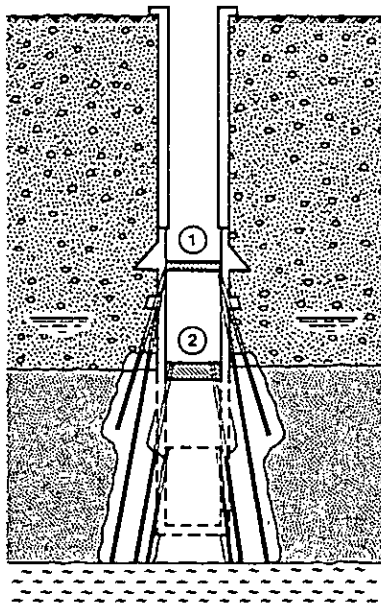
Sables fins bouillants, consolidation pour le creusement d'un puits (doc. Solétanche)
